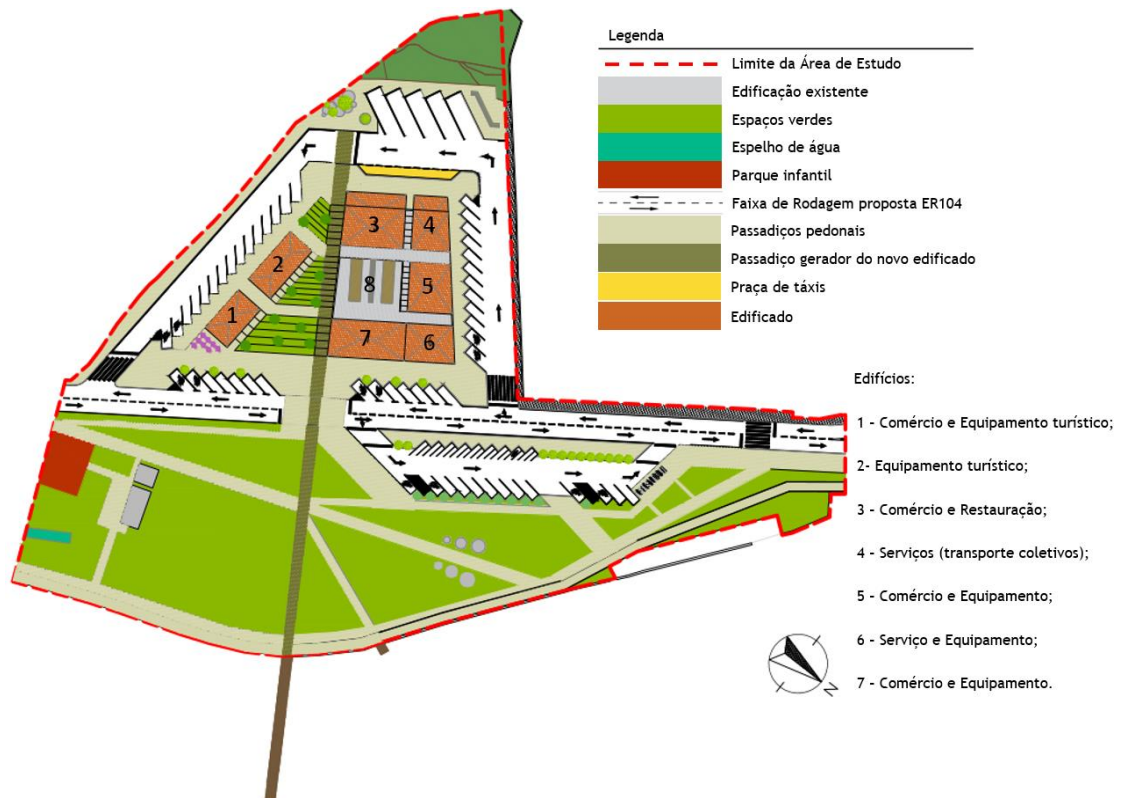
Planta esquemática: Zona de Equipamento. Edificação proposta. [s/escala]
